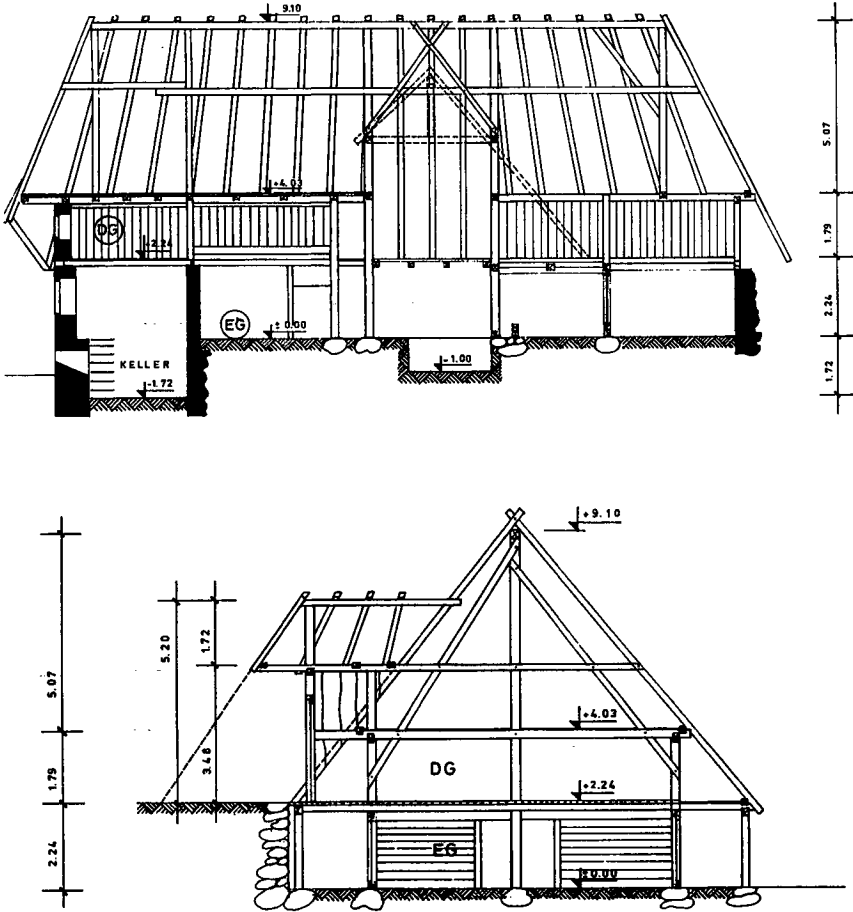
Das Holzgerüst des Klausenhofes; oben: Längsschnitt (Schnitt A-A in Abb. 9 und 10); unten: Querschnitt (Schnitt B-B in Abb. 9 und 10). (Zeichnungen: Verf.)
